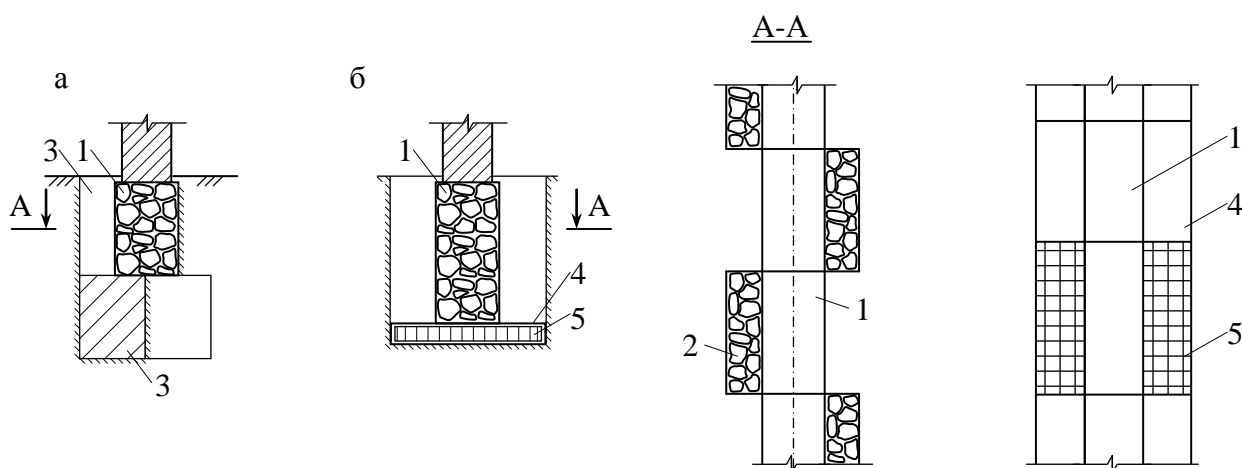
Конструктивні рішення підведення фундаменту: а – стовпи з шаховим розміщенням у плані; б – залізобетонні плити; 1 – фундамент; 2 – стовп; 3 – шурф; 4 – плита; 5 – арматурний каркас
